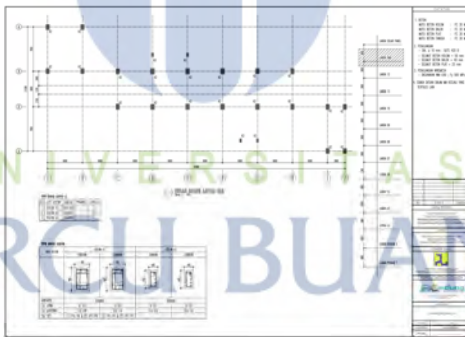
9 Detail struktur kolom lantai 7 dan 8
